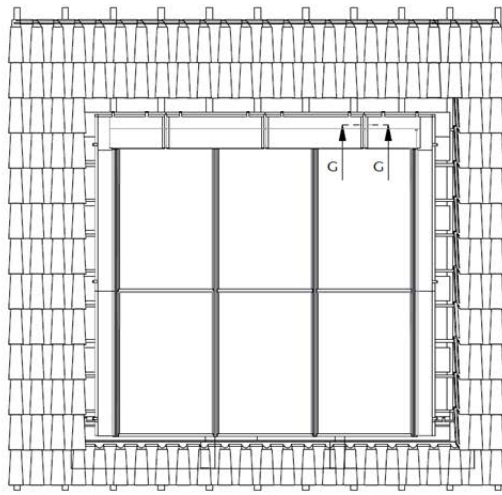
Pose de l'abergement supérieur droit pour installation sur toiture tuile
